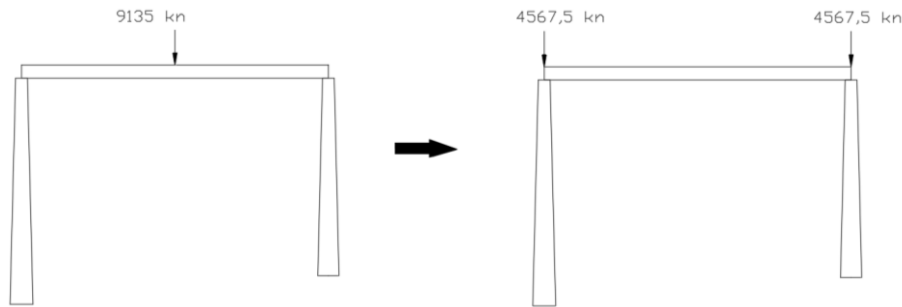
Cargas puntuales en Pila 2 y Pila 3
